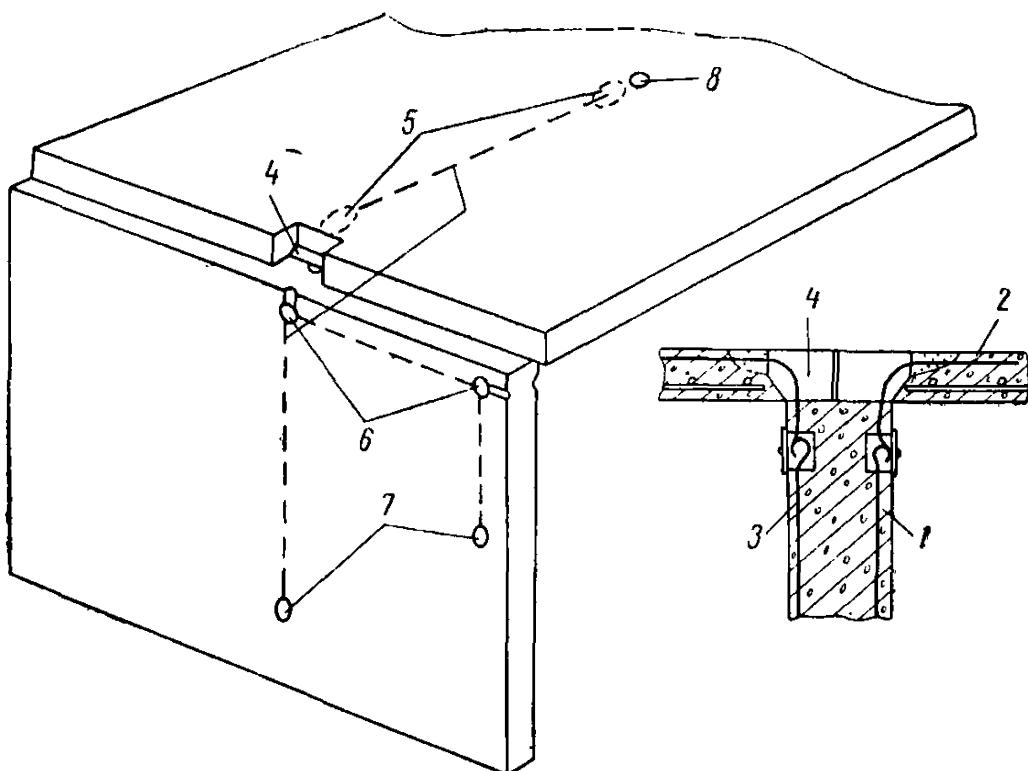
Узел сопряжения электропроводок, замоноличенных в стеновую панель и панель перекрытия
